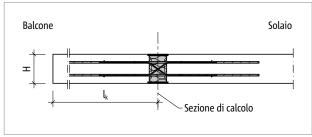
Schöck Isokorb® XT tipo DL: schema statico
